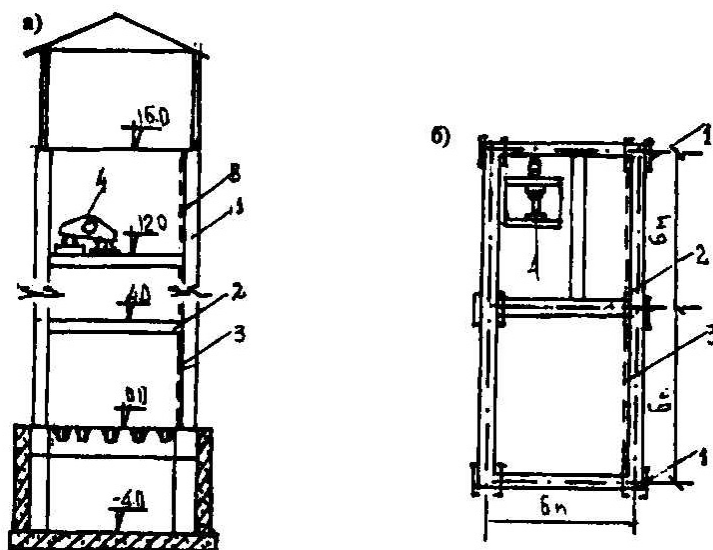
а – схема этажерки под грохот ГИТ-51, б – план перекрытия стойки (IN55), 2- балки перекрытия, 3 -связи в вертикальной плоскости, 4 – грохот ГИТ-51
